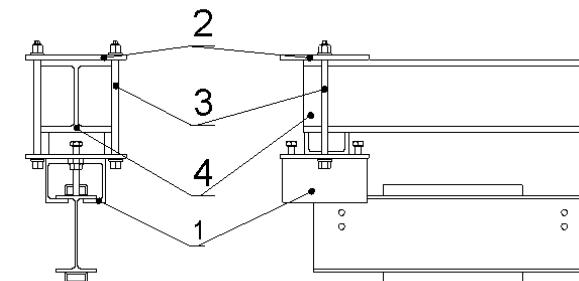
Крепление без сверления отверстий в несущей конструкции
